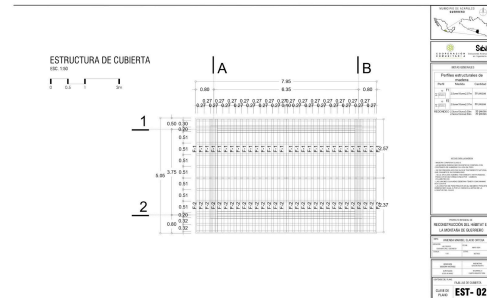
Estructura de cubierta: fajillas (EST-02)
